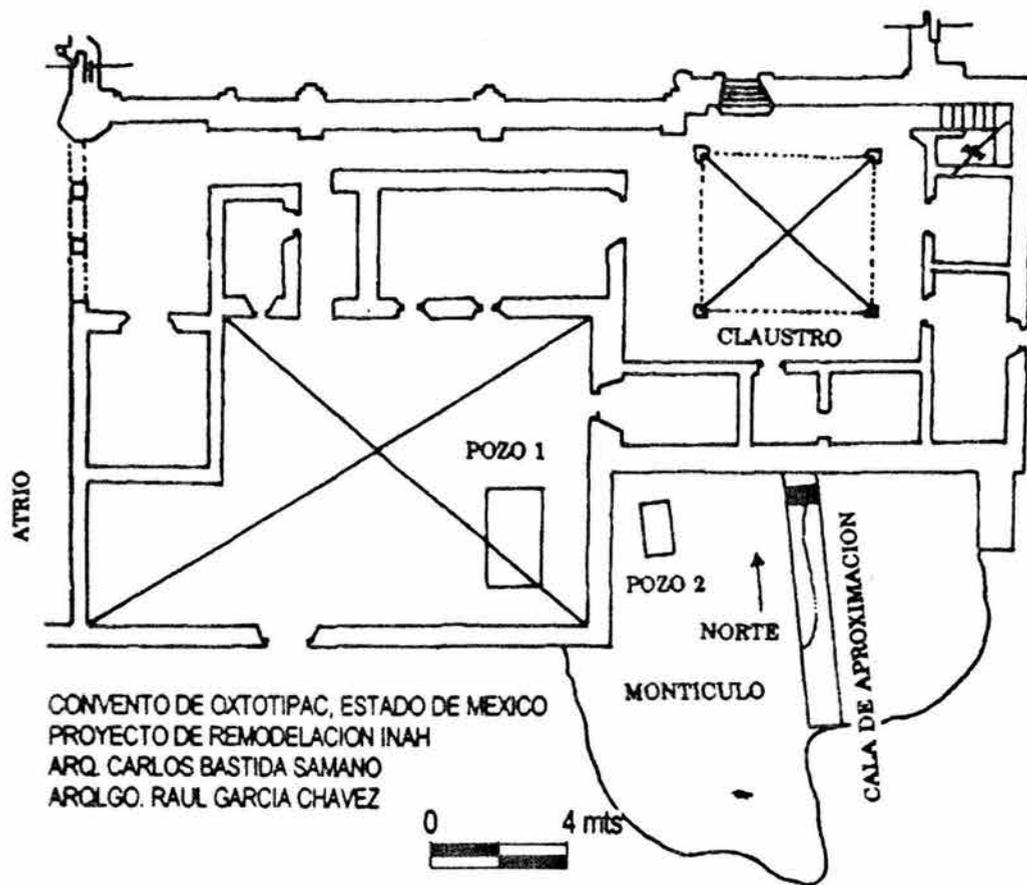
Planta del convento de Oxtotipac con la ubicación de las excavaciones
